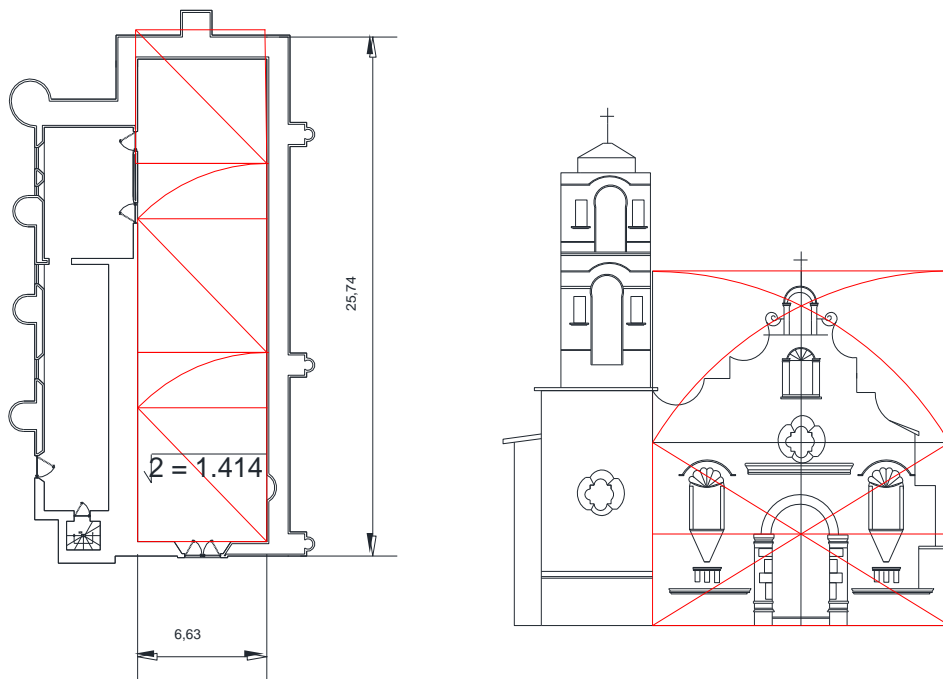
Trazo de la planta arquitectónica y fachada con el rectángulo dinámico, realizo J. O. B.
